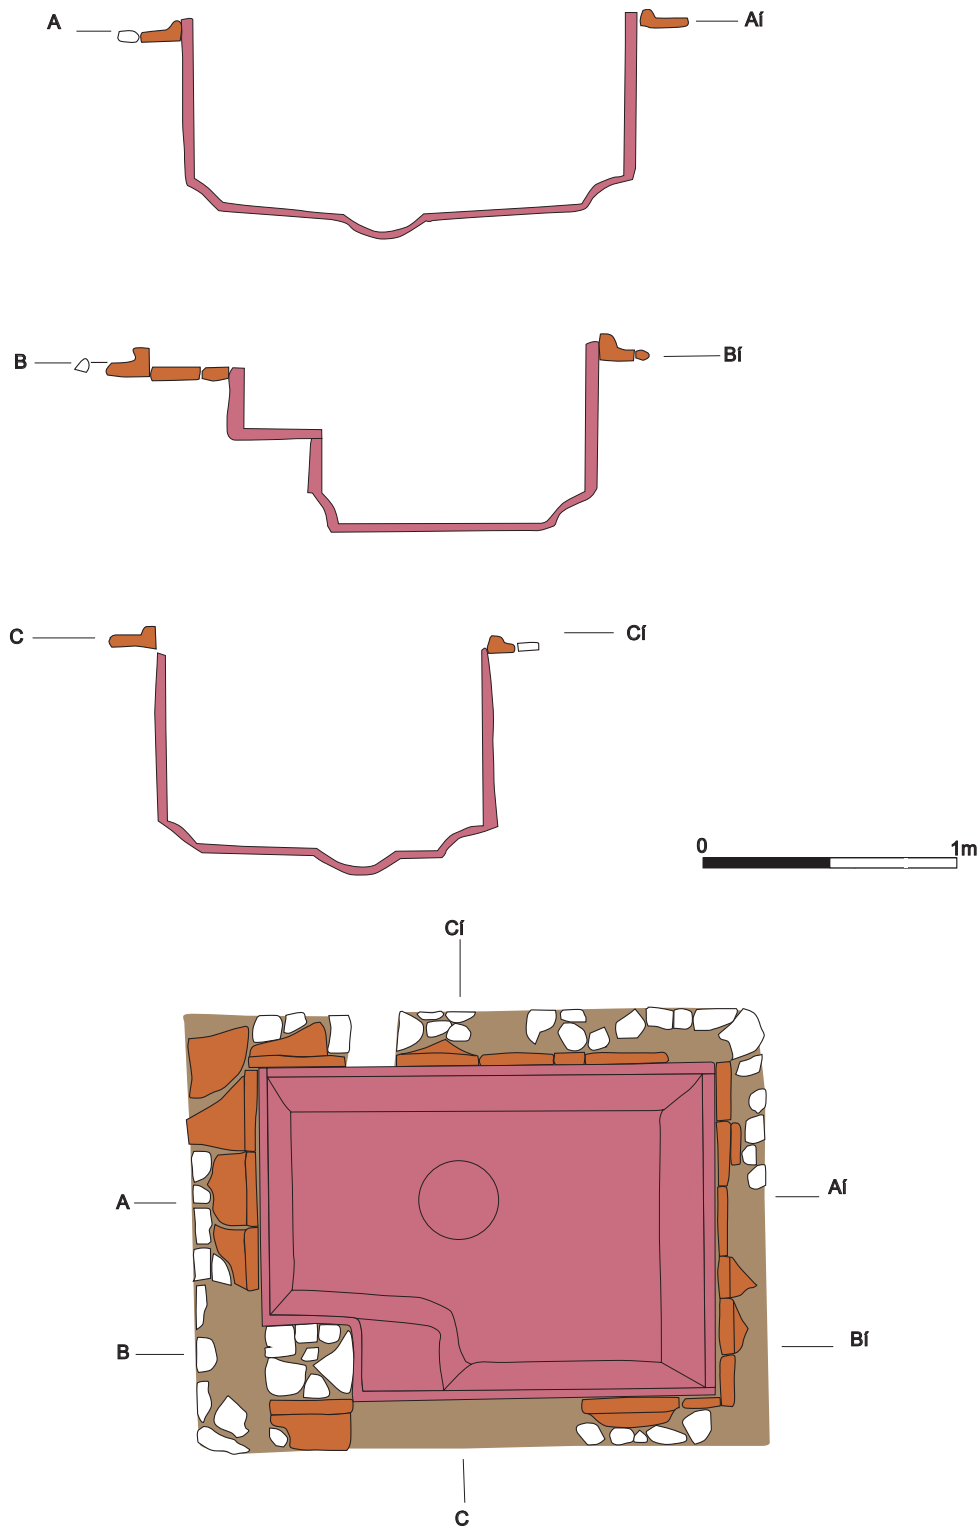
Planta i seccions de l'aljub localitzat al jaciment del Camp del Bosquet, Camallera. Font: Nolla/Casas 1984.
